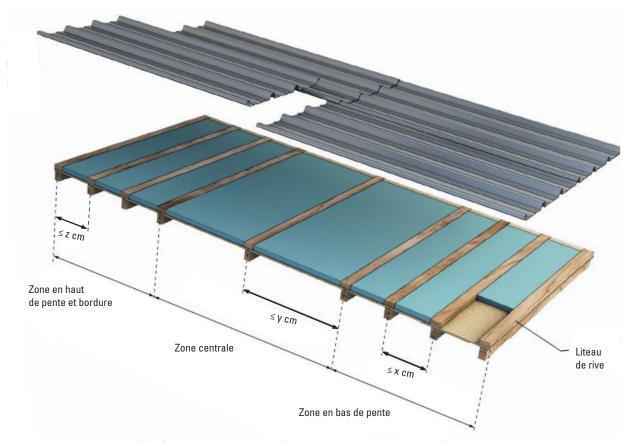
Liteaux fixés à la structure porteuse à travers un parement décoratif bois continu posé sur pannes
